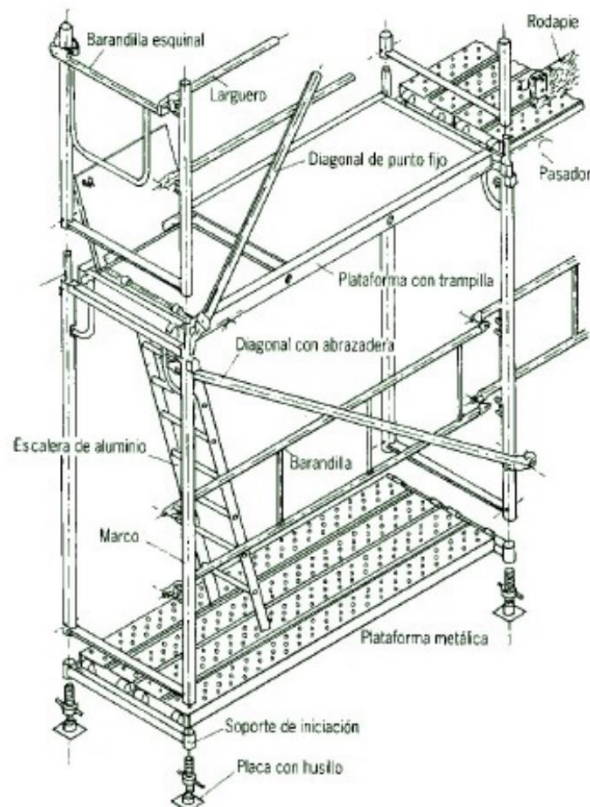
Partes de un andamio fijo prefabricado sistema modular
